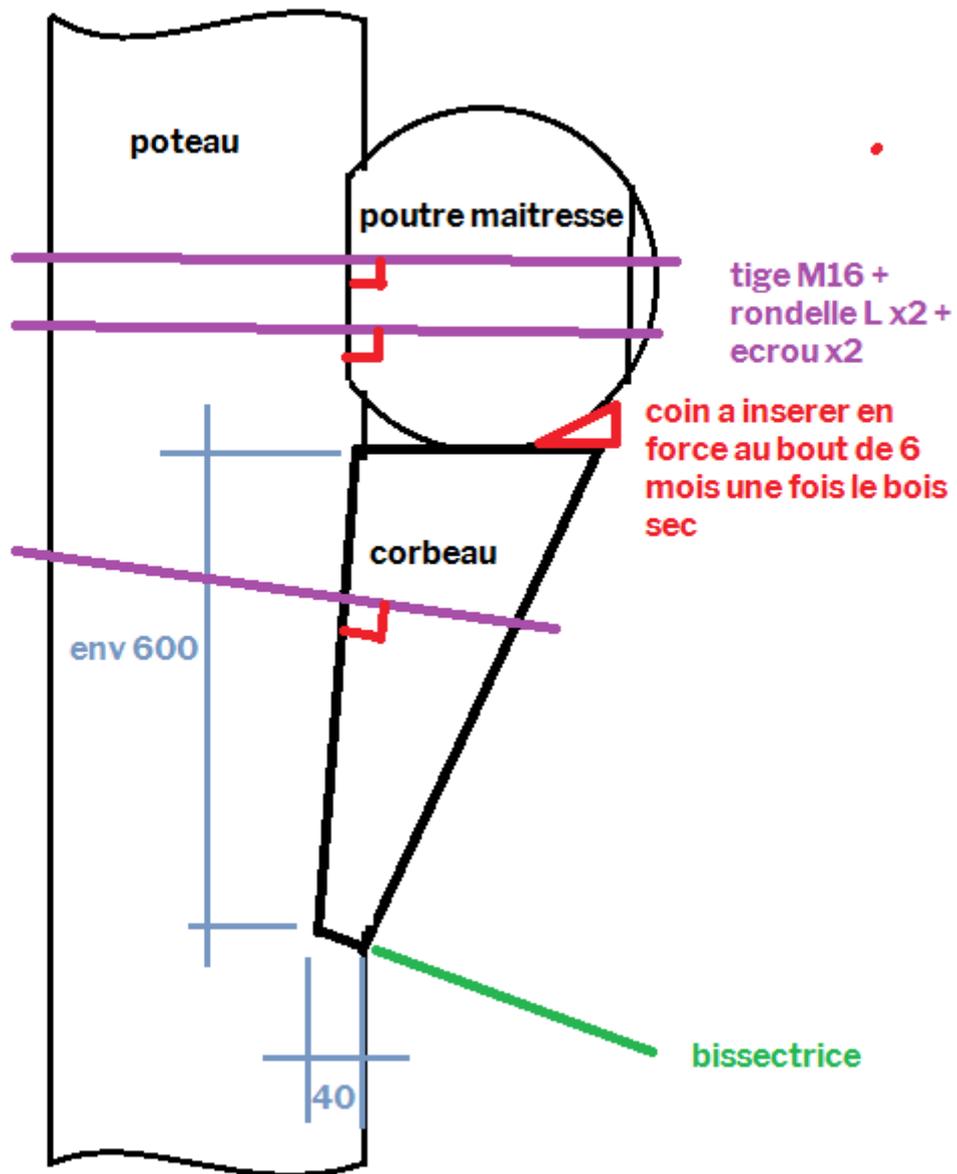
Corbeau pour soulager les tiges filetée et reprendre les efforts du plancher sur la poutre maitresse
